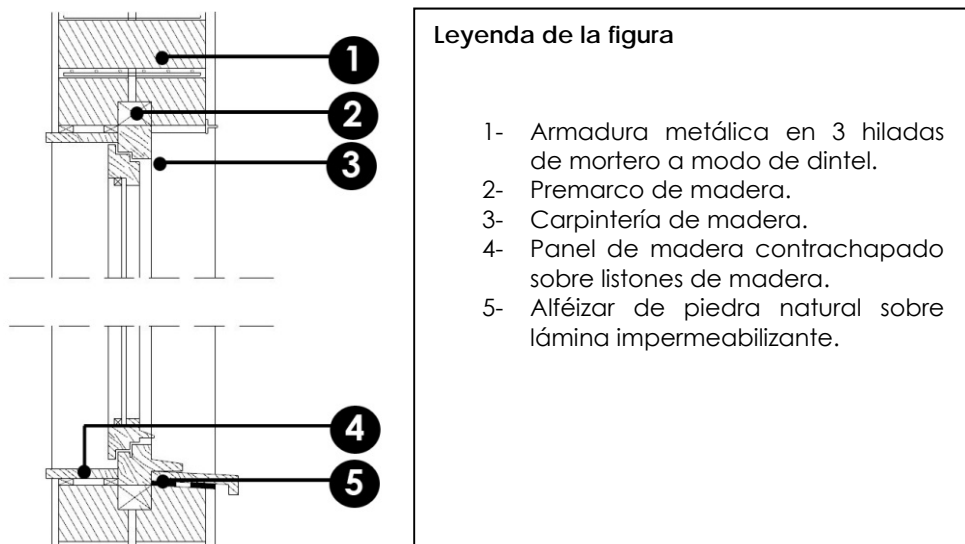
Fachada Sur. Hueco. BAR-002. Fuente: Gabriel Barbetá – David Pradas Ruiz. Elaboración propia.
